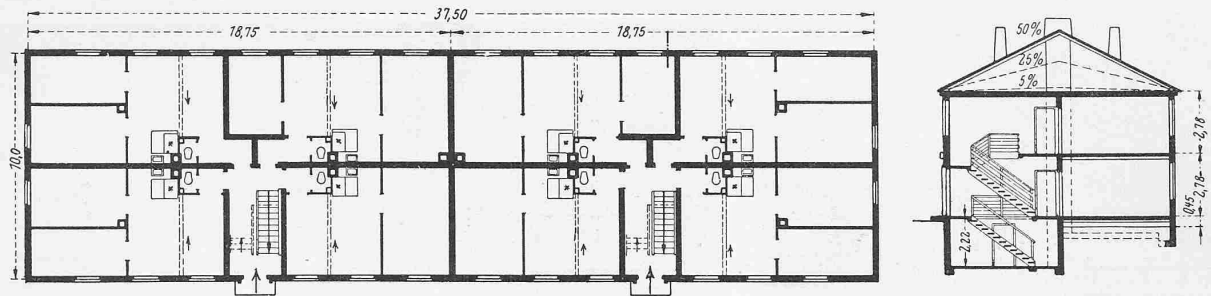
Deutsches Kriegs-Einheitswohnhaus nach Prof. E. NEUFERT (Berlin), Grundriss und Schnitt 1:300
